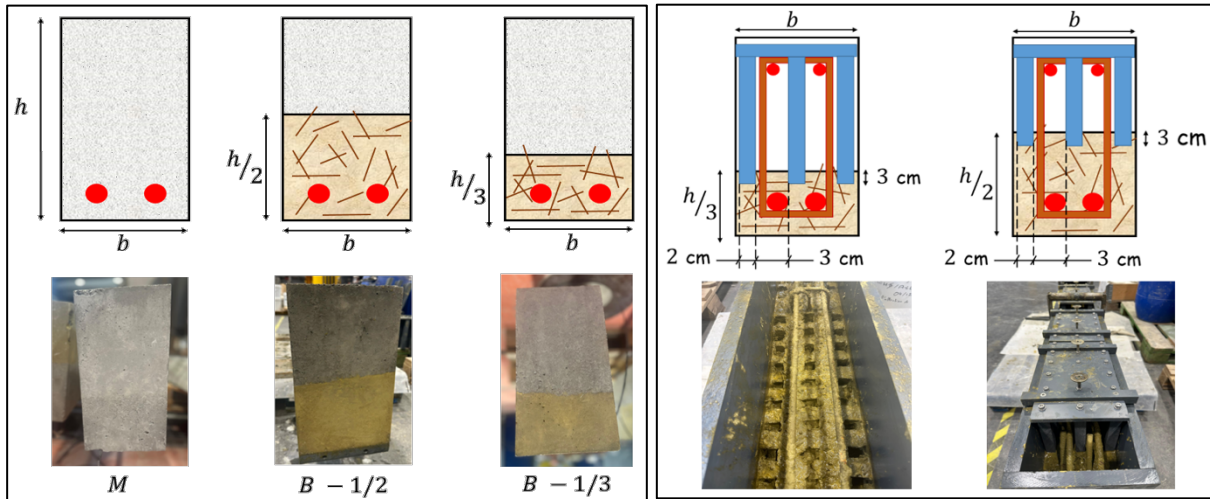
Configurations des poutres testées : M : poutre monolithique en béton ordinaire ; B-1/2 : béton fibré sur la moitié inférieure ($h/2$) ; B-1/3 : béton fibré sur le tiers inférieur ($h/3$).
